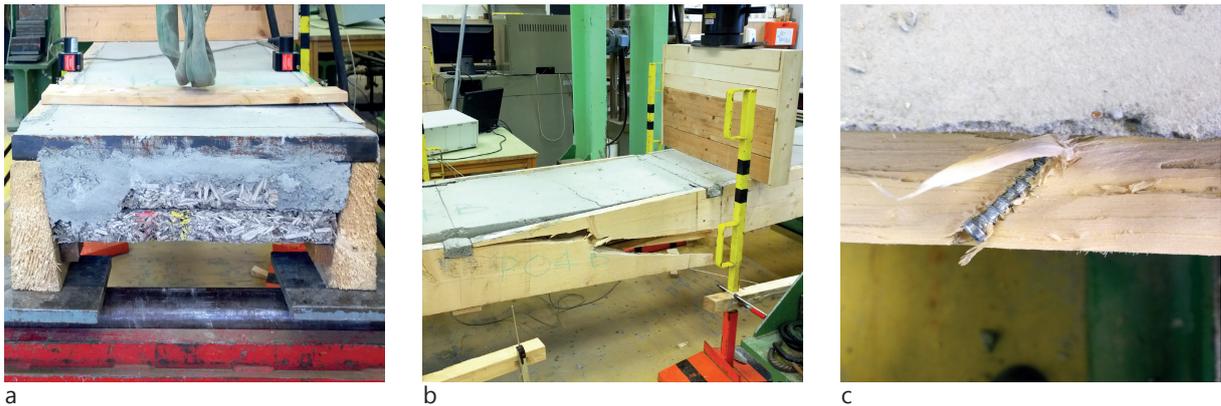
Belastungsversuche Holzträger mit Holzleichtbeton- und Beton-Verbund; a Aufbau eines Versuchskörpers mit Stahlprofilen; b Bruchversagen im Belastungsversuch; c Verformung Hineinziehen der Schraube in das Holz durch Belastung
